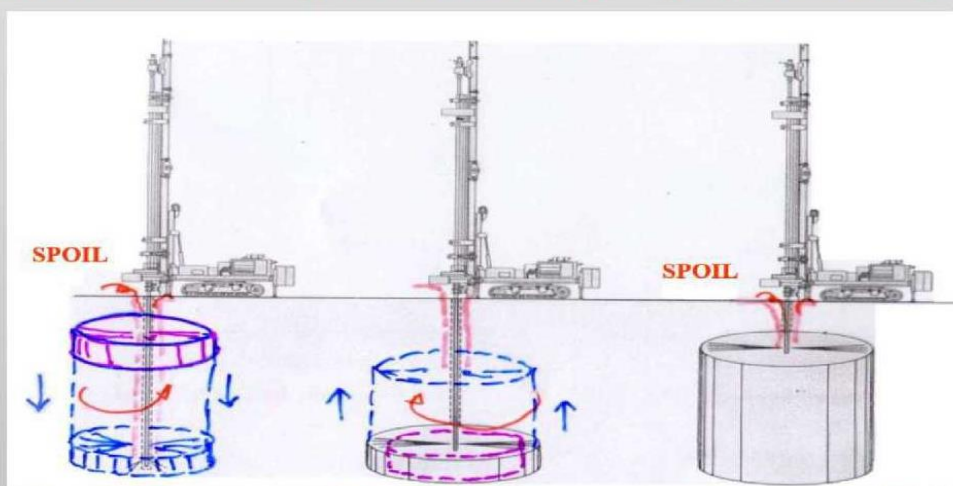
Soil Improvement by Jet Grouting Method
